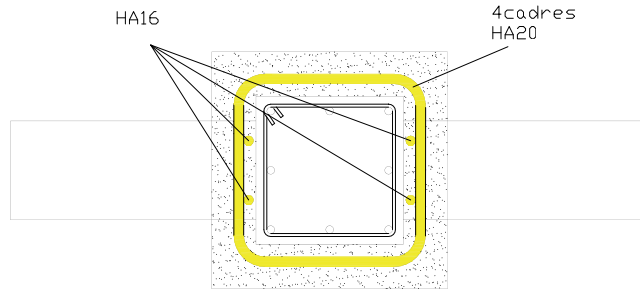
Coupe du chemisage au niveau des poutres.
